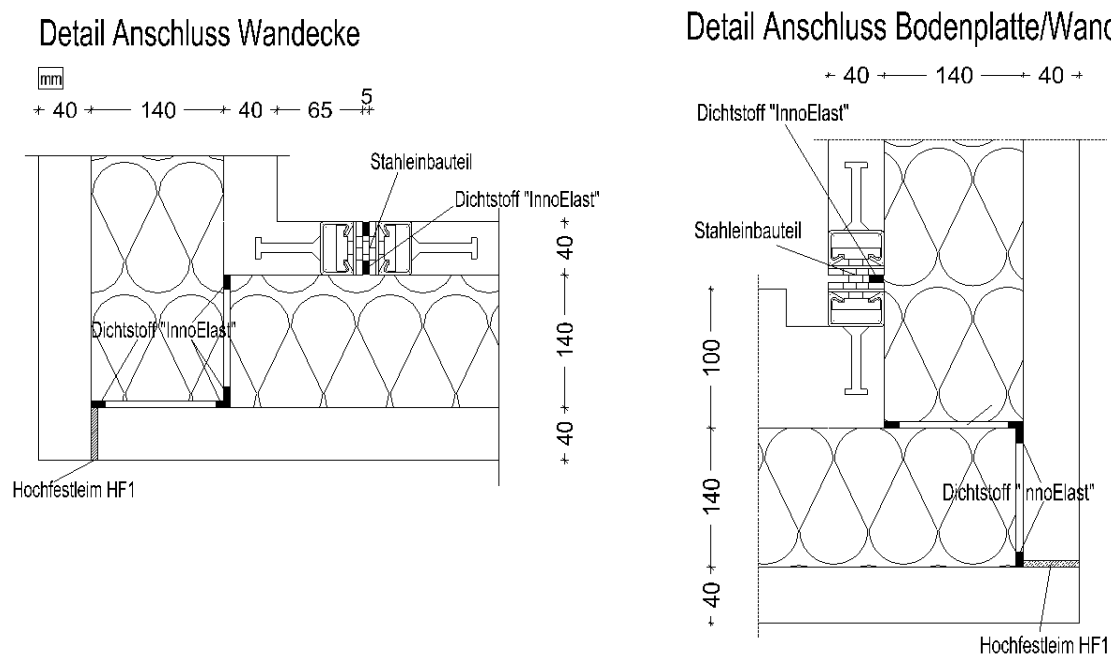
Detailanschluss Wandecke (links); Detailanschluss Bodenplatte/Wand (rechts)
